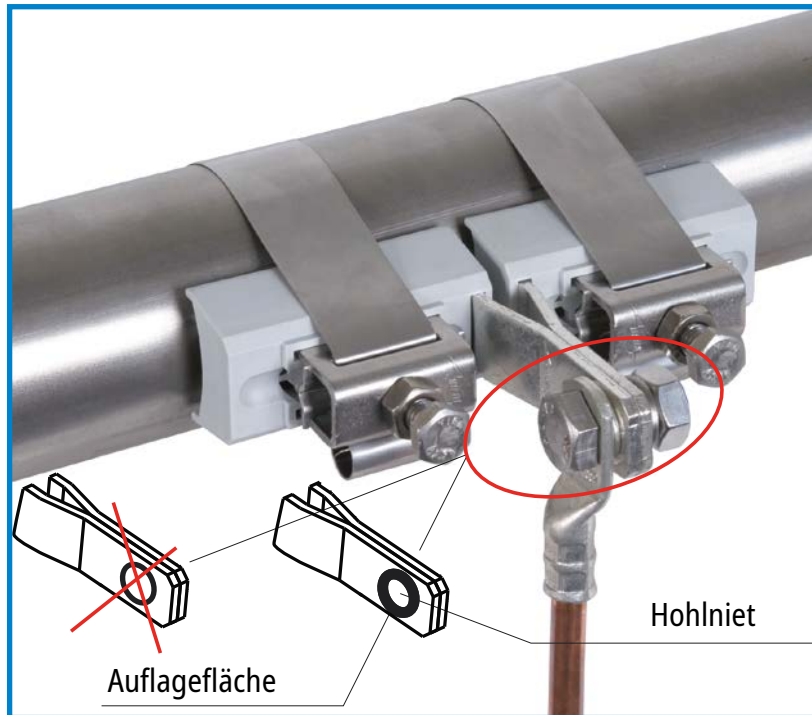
Kabelschuh z.B. für Rundleiter
